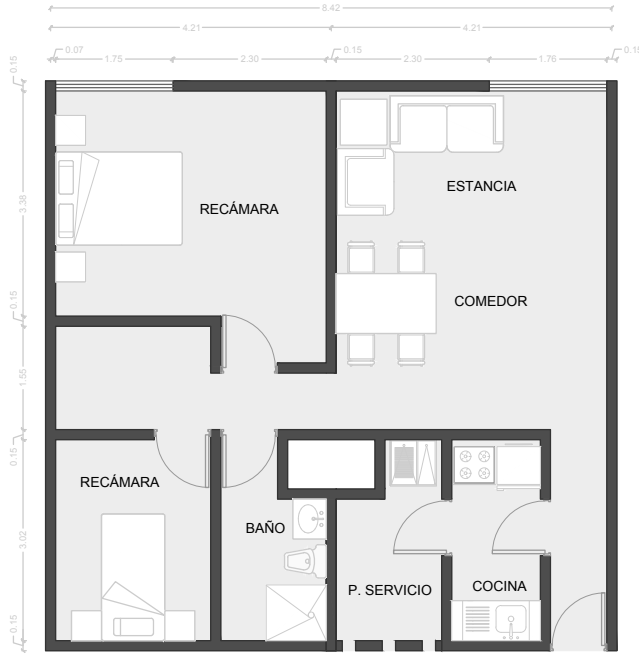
Planta arquitectónica de edificio tipo A, Fuente: Luz Pirr'on y elaboración propia
